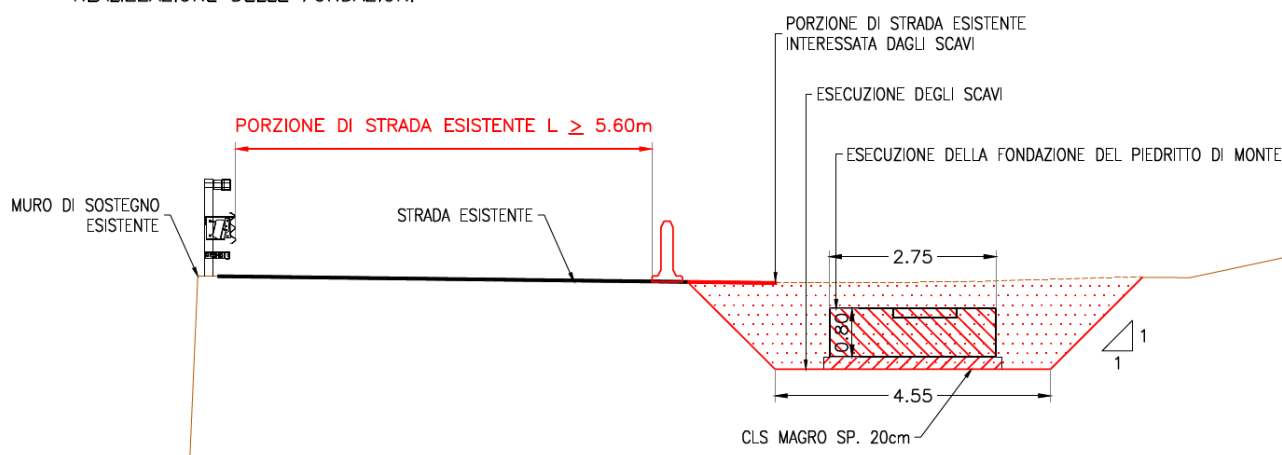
Fase 1, esecuzione fondazione lato monte
